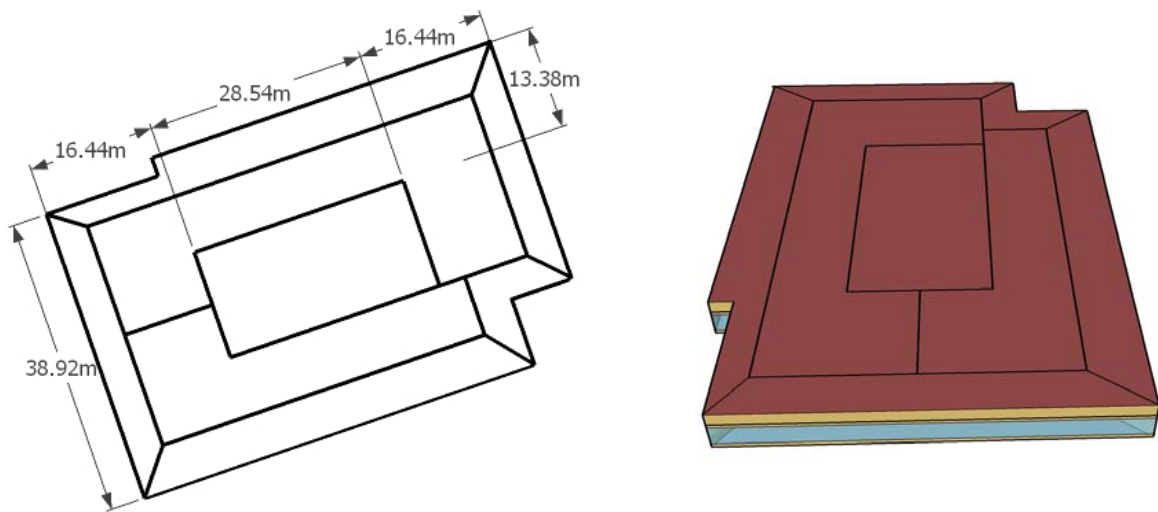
Planta e modelo espacial de pavimento tipo do Proposed Building para o estudo de caso #4
